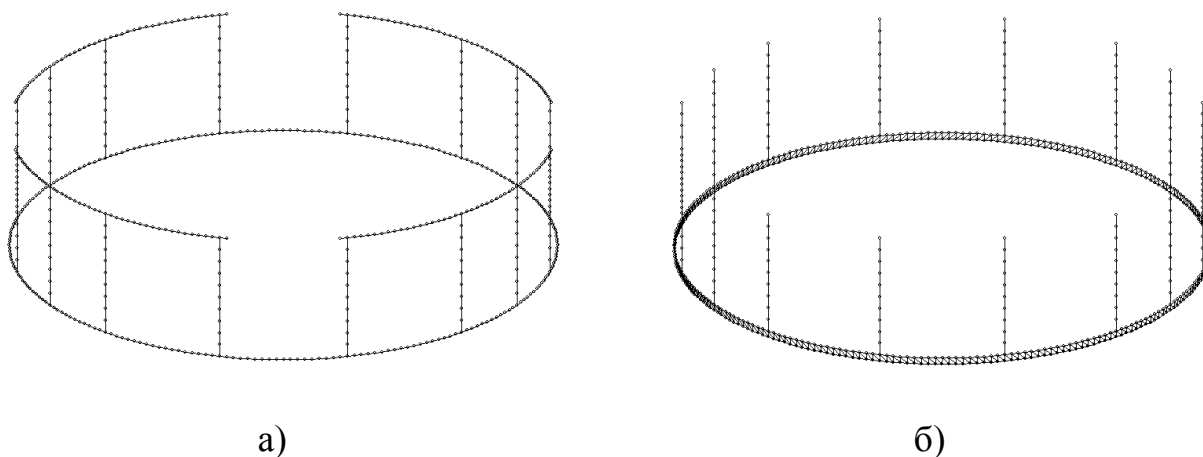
Топологическая схема верхней части конструкции:
